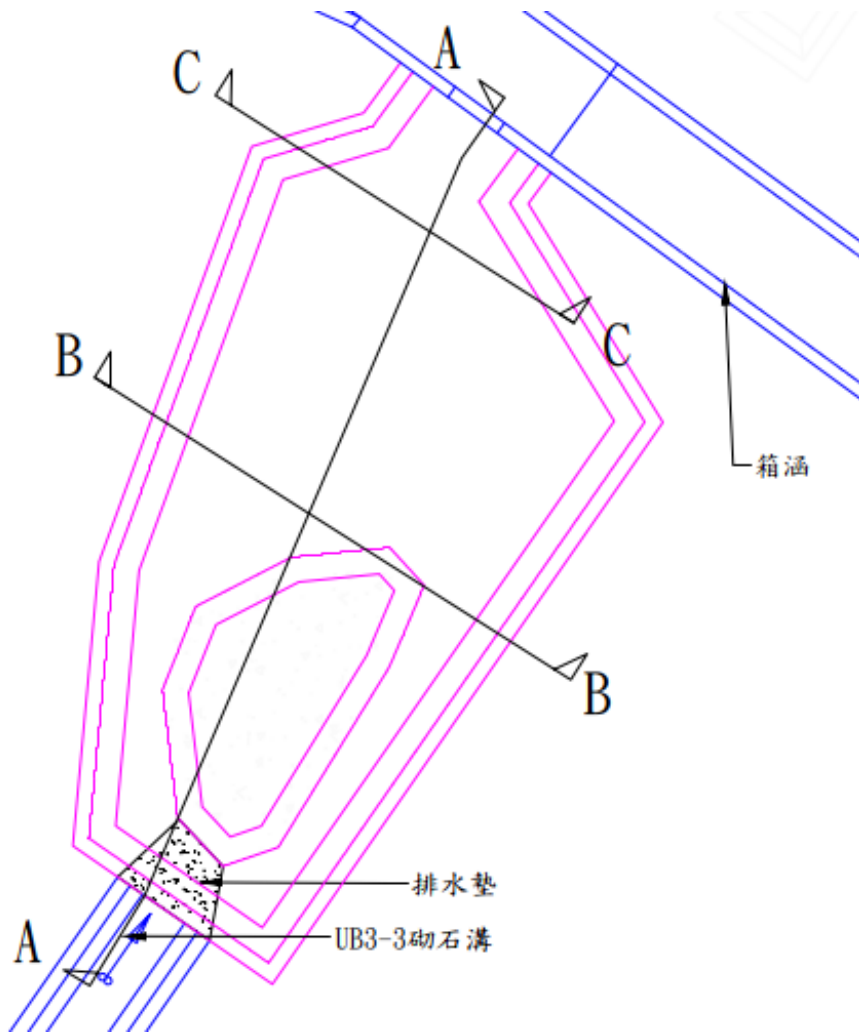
水庫防淤 - DET2 滯洪沉砂池平面圖
